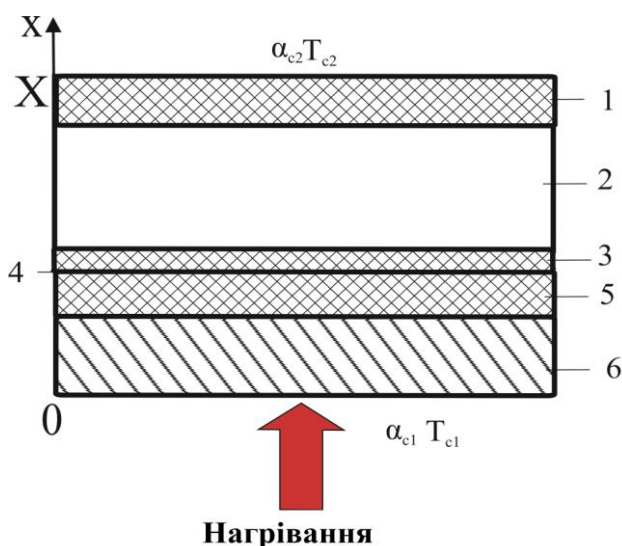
Схема багатопустотного залізобетонного перекриття в одновимірній постановці: 1 – шар суцільного бетону між необігрівною поверхнею і шаром з пустотами перекриття; 2 – шар з пустотами; 3 – шар суцільного бетону між пустотами і арматурою; 4 – шар арматури; 5 – шар суцільного бетону від арматури до поверхні, що обігрівається; 6 – штукатурне покриття
